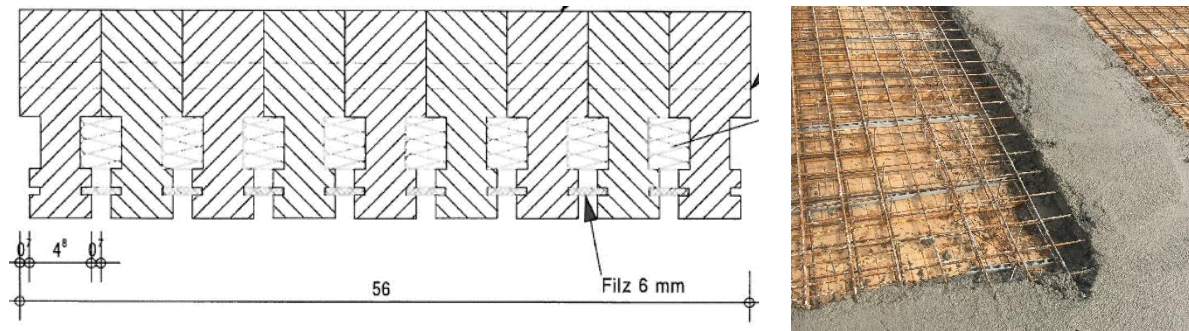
Querschnitt Brettstapelelement mit integrierter Akustik und Betonierung vor Ort mit Normalbeton unterhalb der Wände
